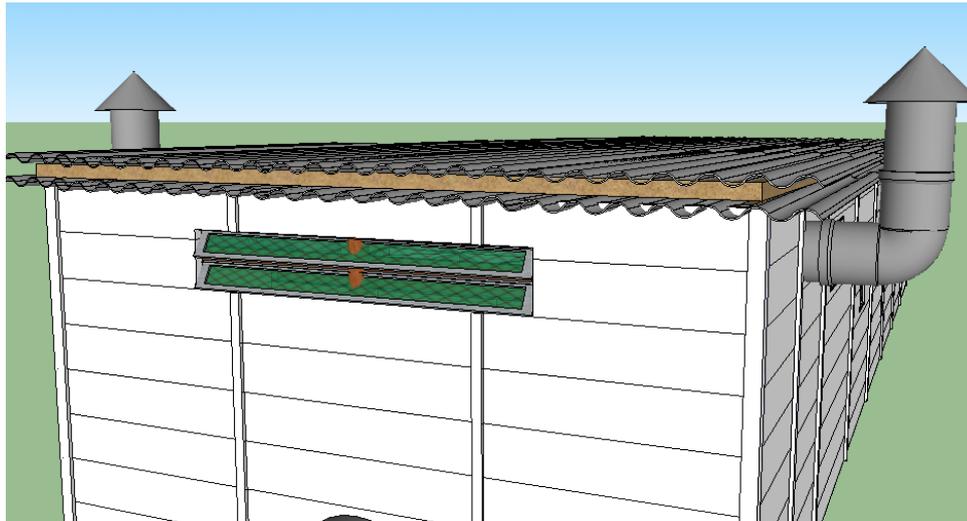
Perspectiva da concepção do telhado da estufa de tabaco.
